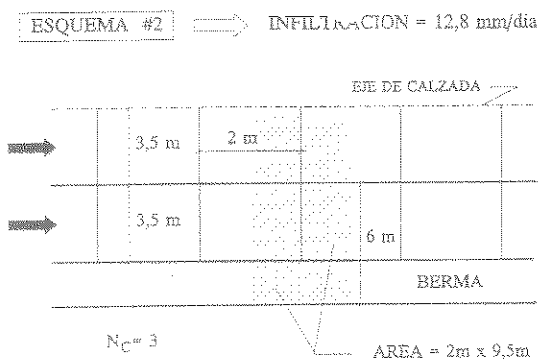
Esquema del modelo de Infiltración aplicado a calzada unidireccional.
